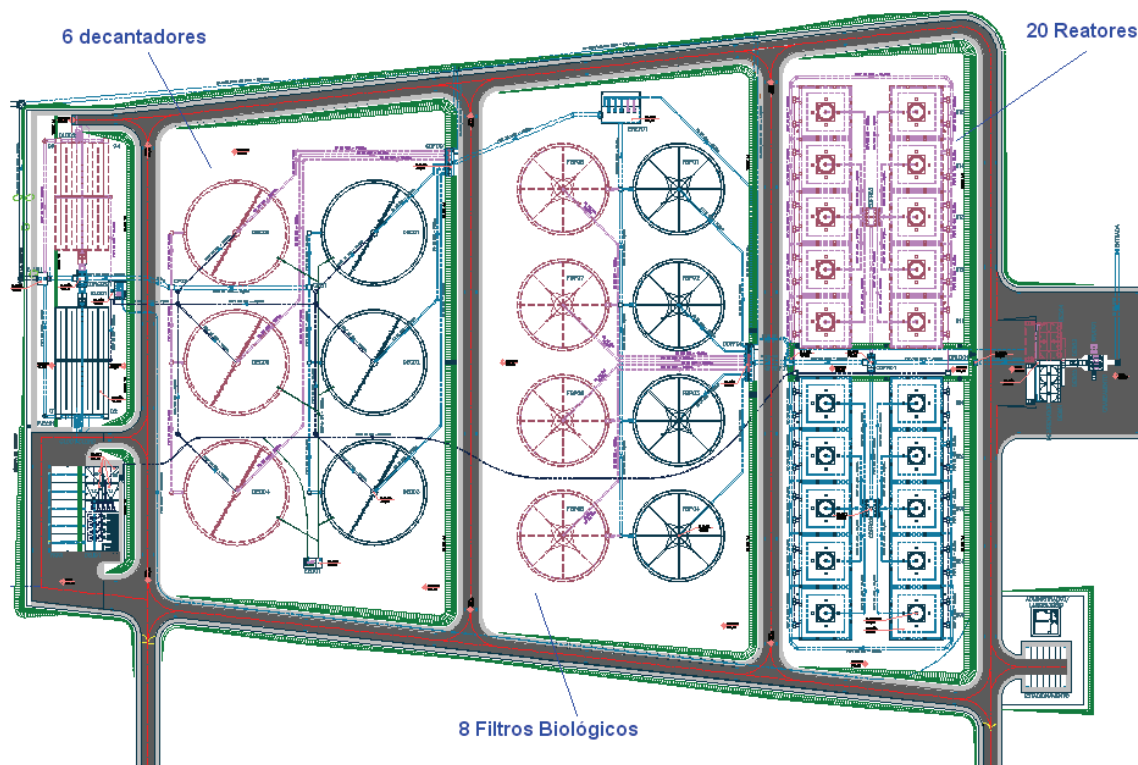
Planta baixa de uma estação de tratamento de esgoto.
